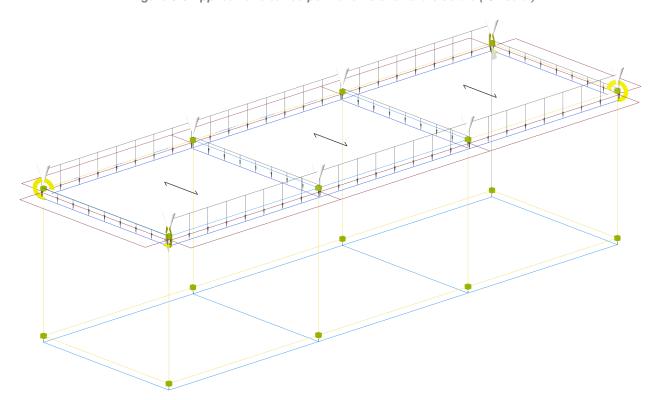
Applicazione carico permanente non strutturale solaio (QFissi solai).
